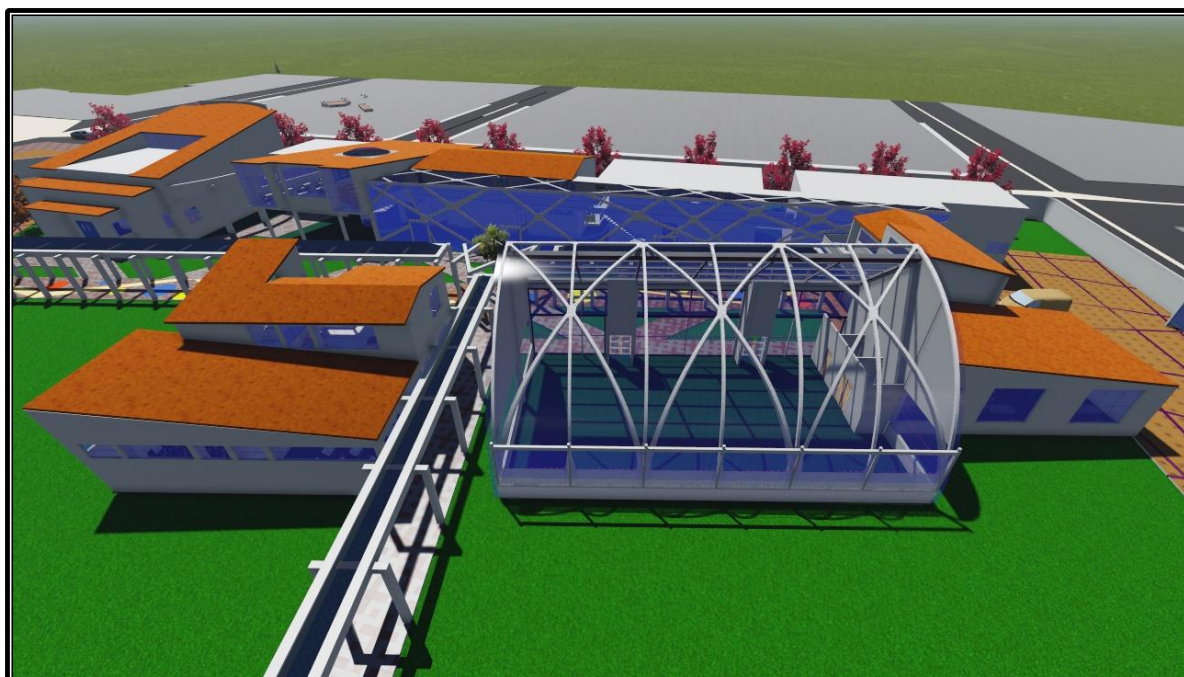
ELEVACION VIVIENDA JUVENIL II - COMEDOR
